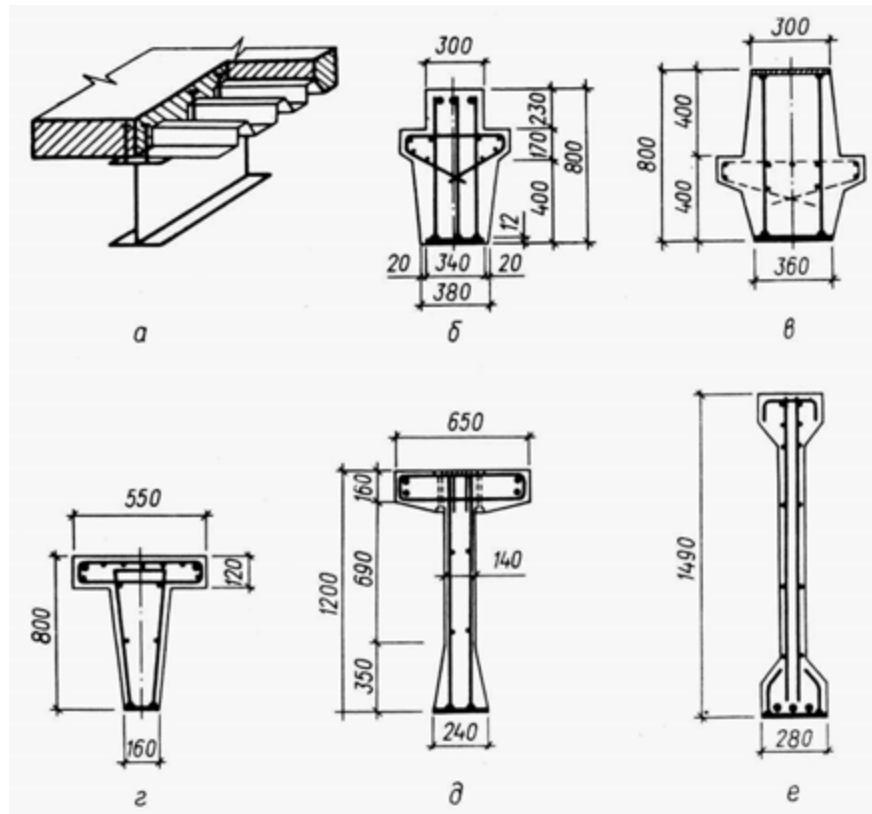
Поперечні перерізи сталобетонних балок із зовнішнім армуванням:
